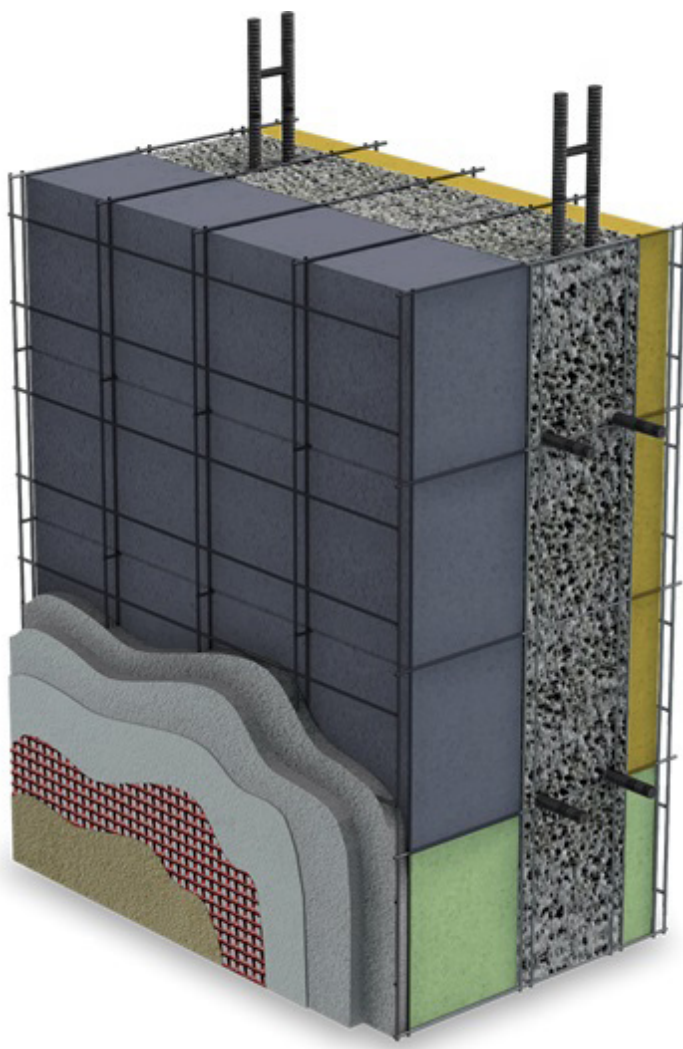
Модель стены из железобетона с чрезвычайно высокой звукоизоляцией
